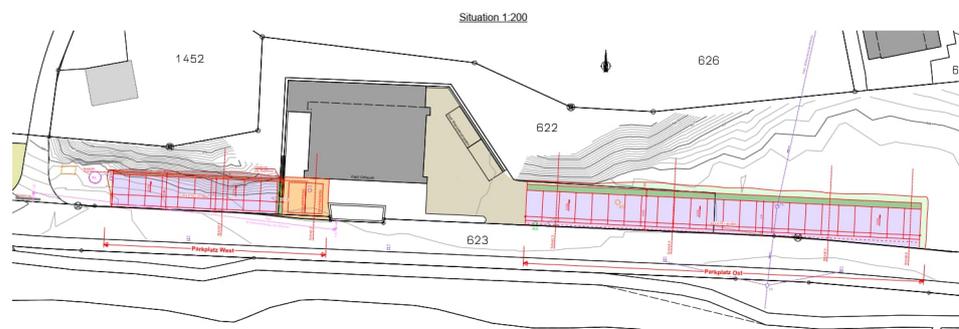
Situationsplan Bauprojekt (Vorprojekt), Gasser Engineering AG, rev. 17.08.2023
